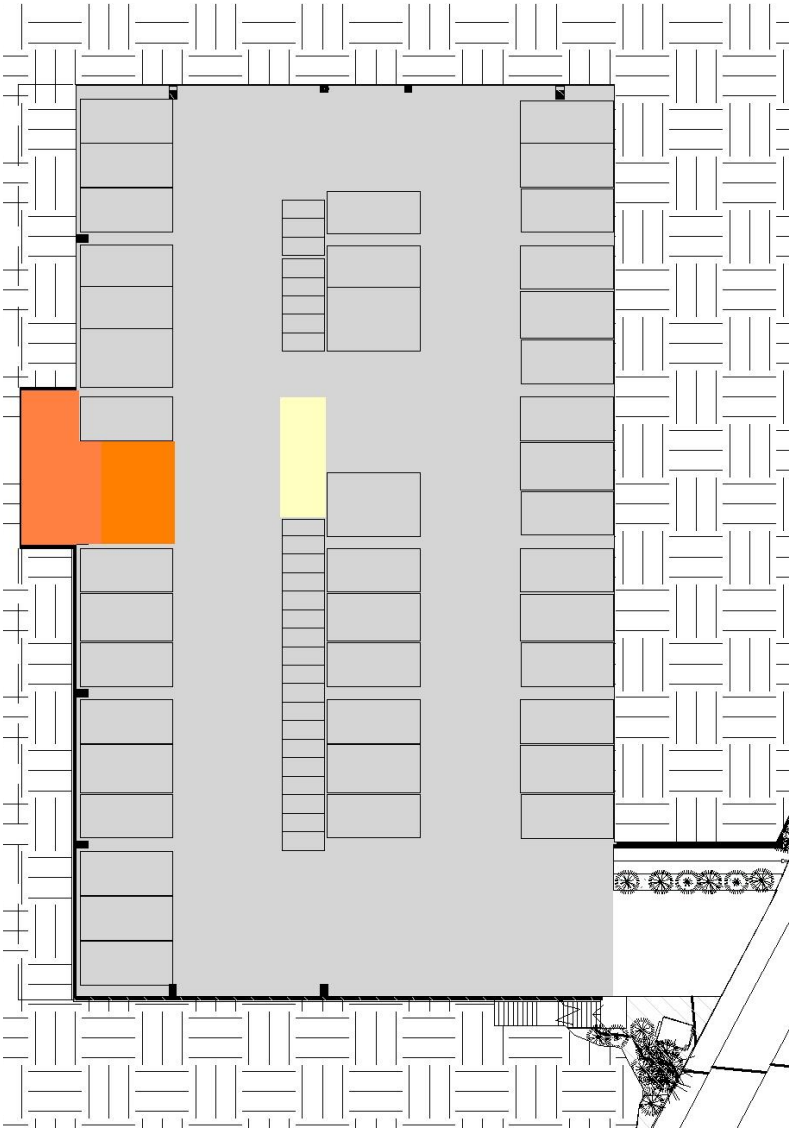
Zonificación, planta de sótano. Fuente propia.
